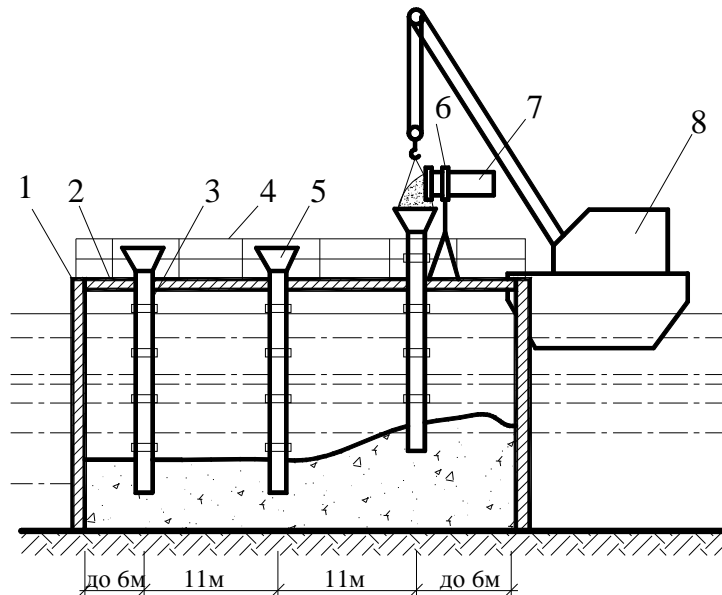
Підводне бетонування методом вертикального підйому труб:
